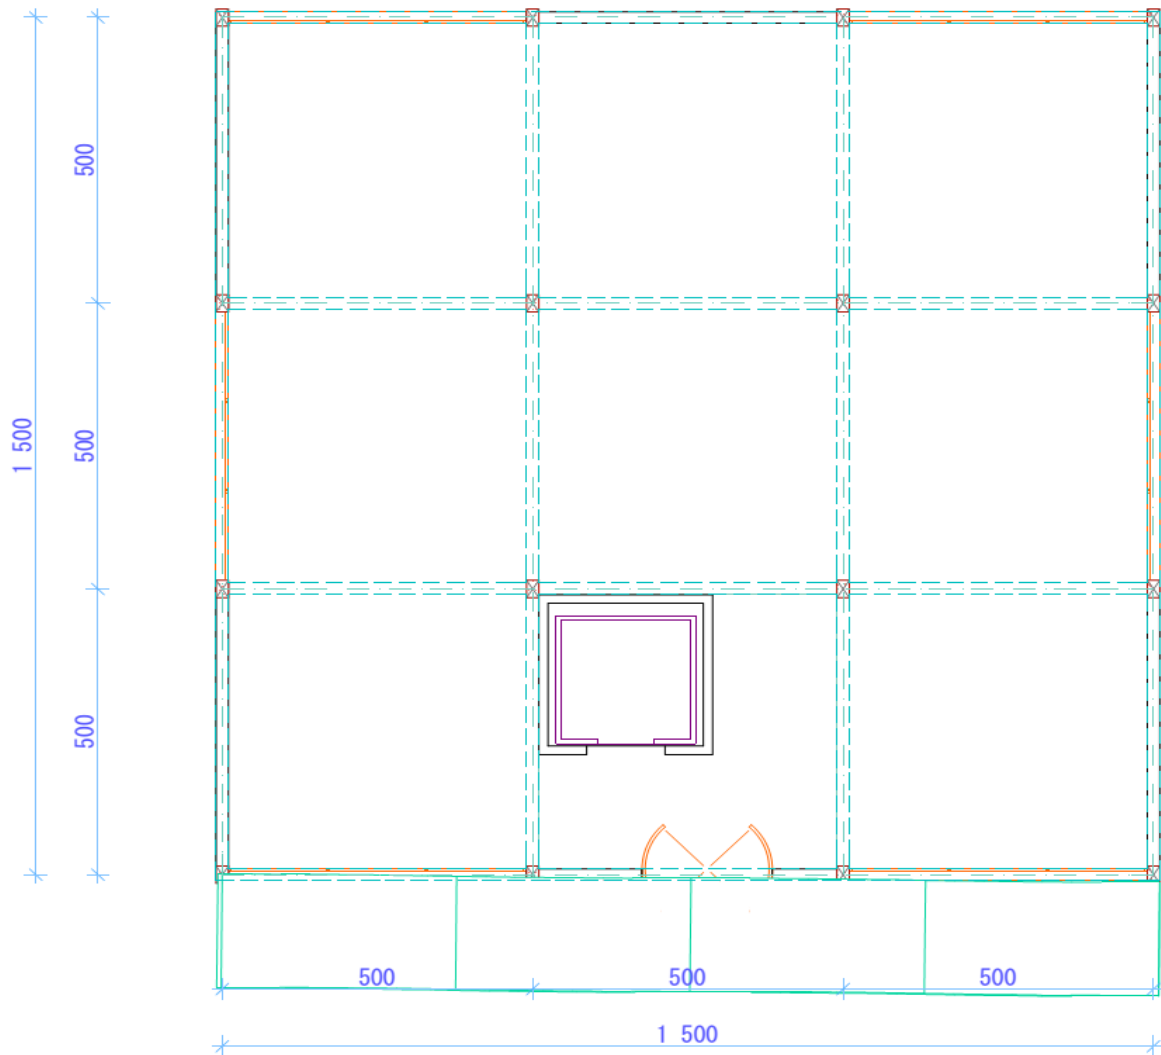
Vue en plan rez de chaussée (l'unité en centimètre)
